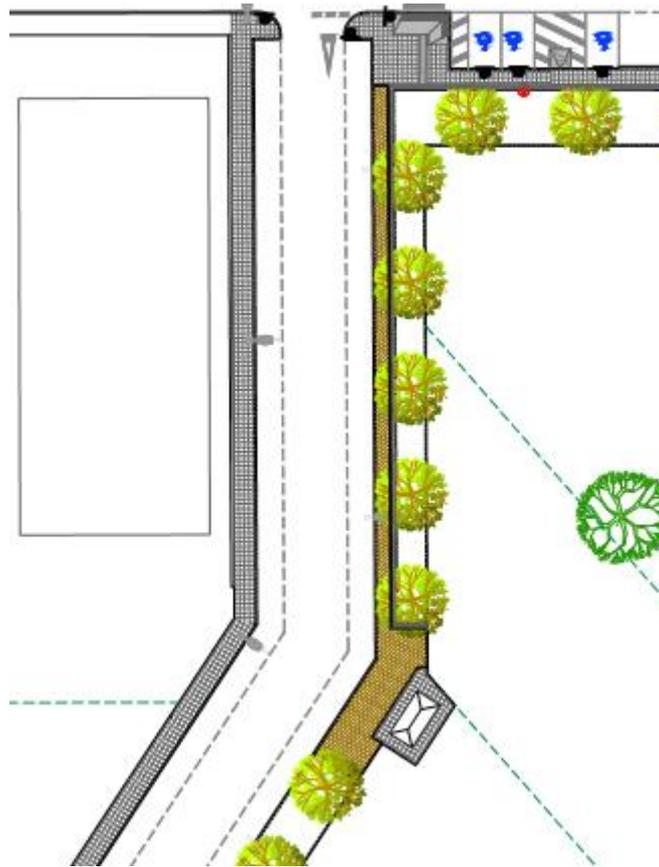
Pavimento drenante (en marrón) para dar acceso a dos solares y al CT del sector.
